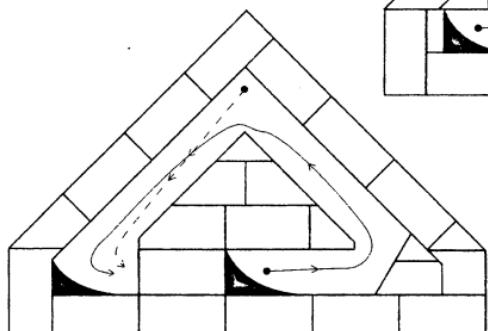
Кладка отопительной треугольной печи № 5 (продолжение)
